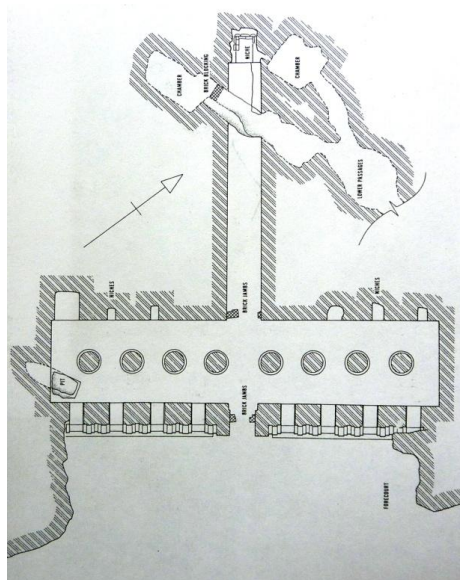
Grundriss der Grabanlage des Senenmut TT 71
